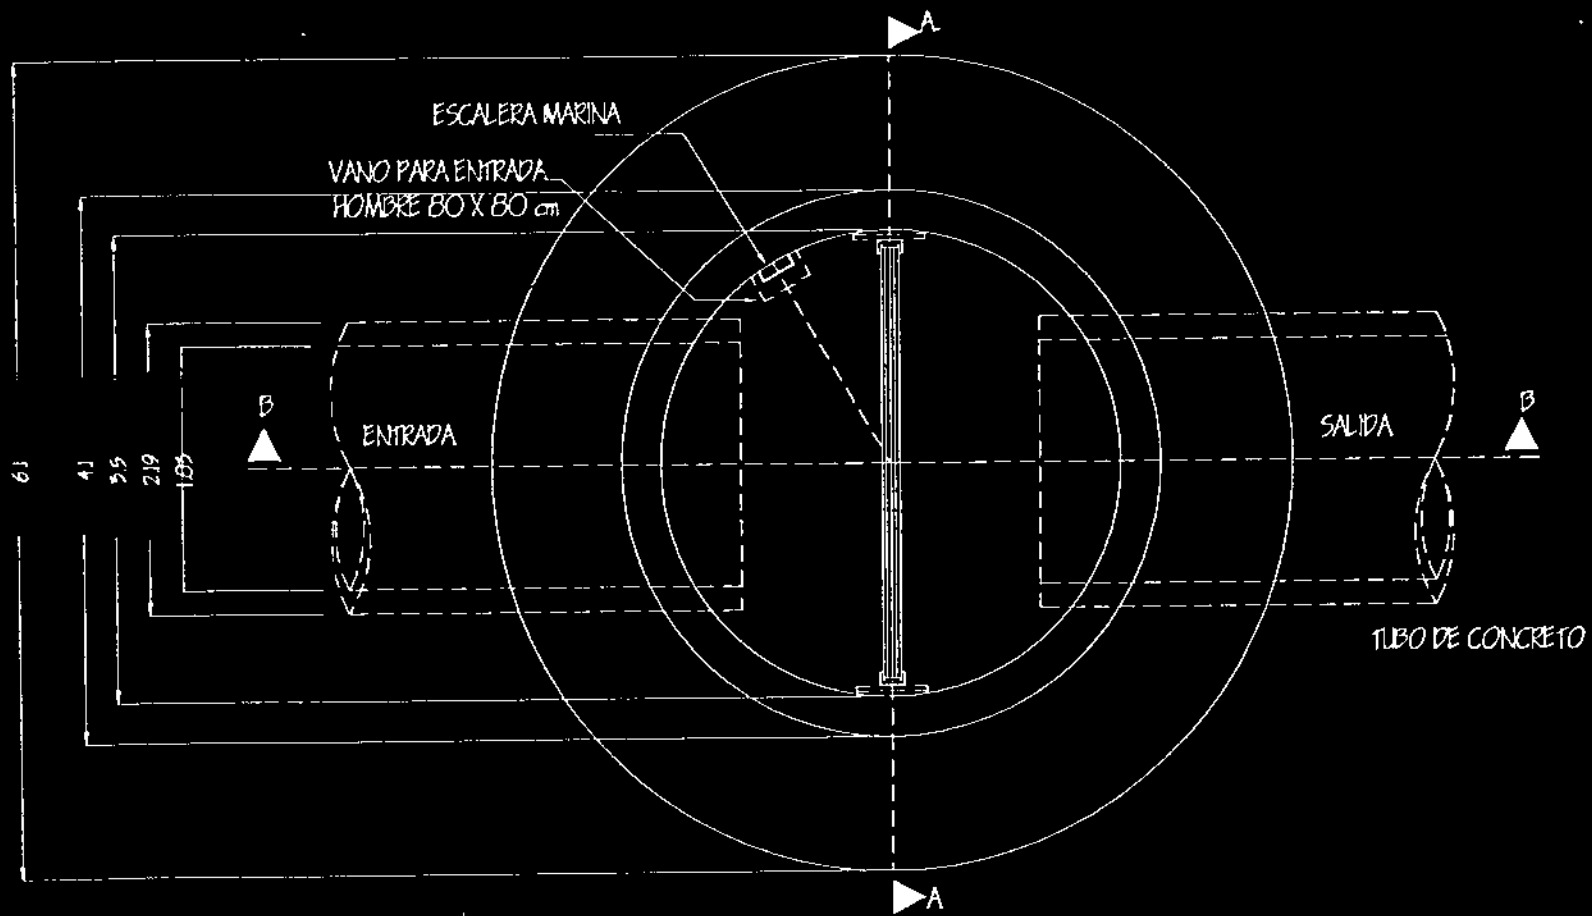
PLANTA DE ESTRUCTURA DE REJILLAS
